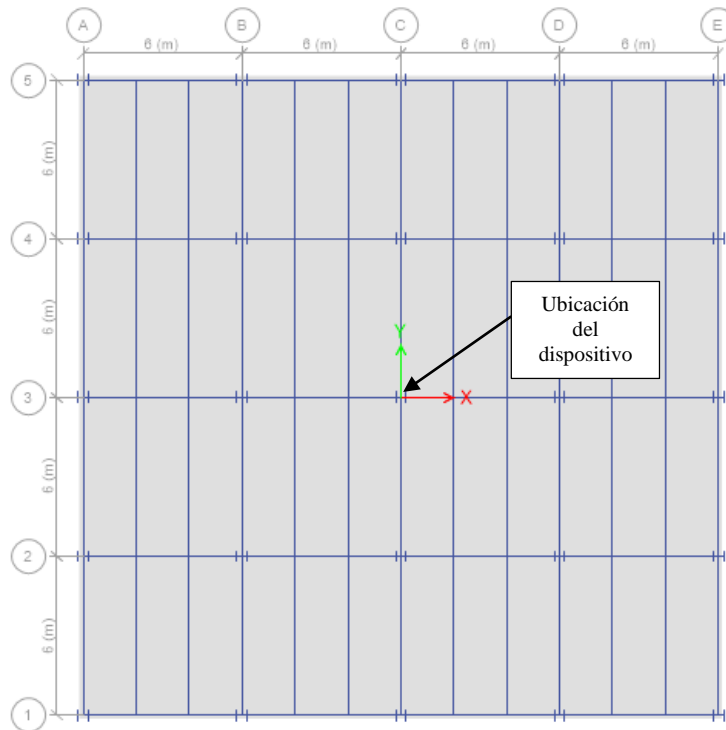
Vista en planta de la estructura en la cual se desea colocar la MSSE
